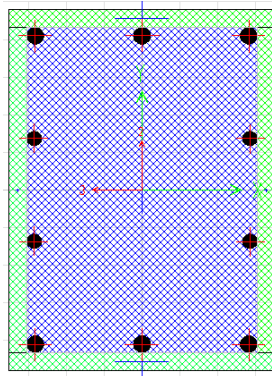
Modellazione della sezione di calcestruzzo armato
